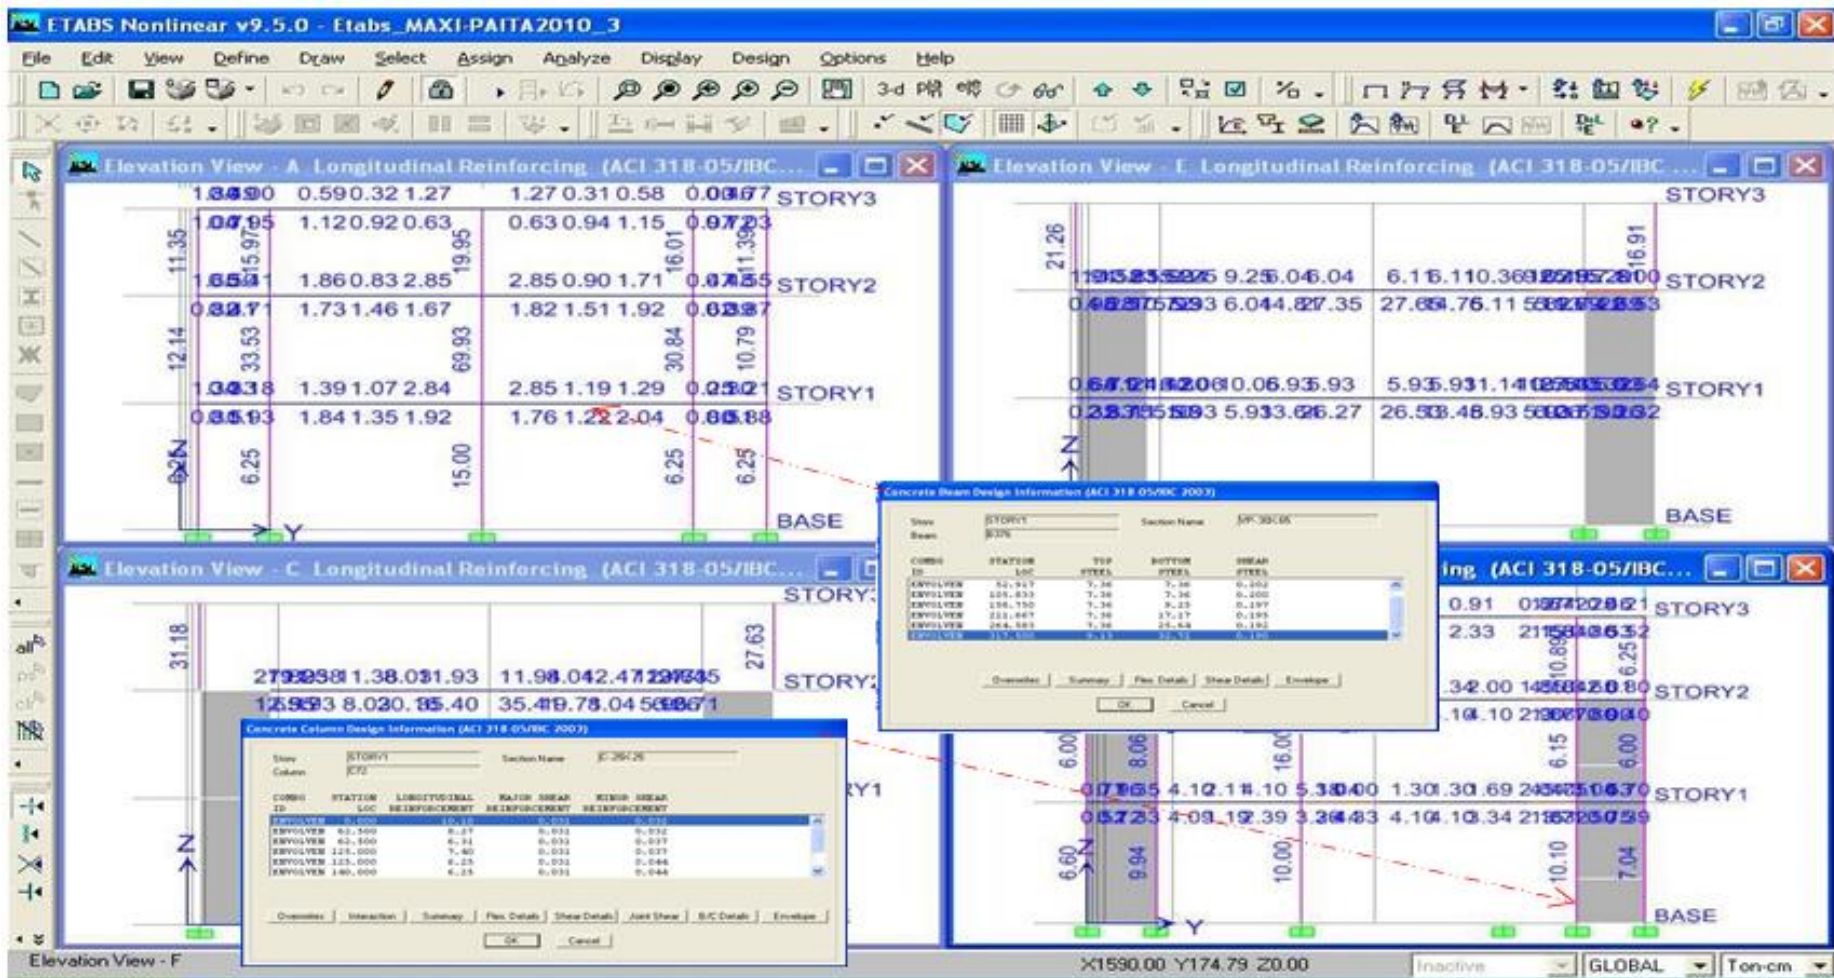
Diseño de refuerzo longitudinal, vista en corte.
